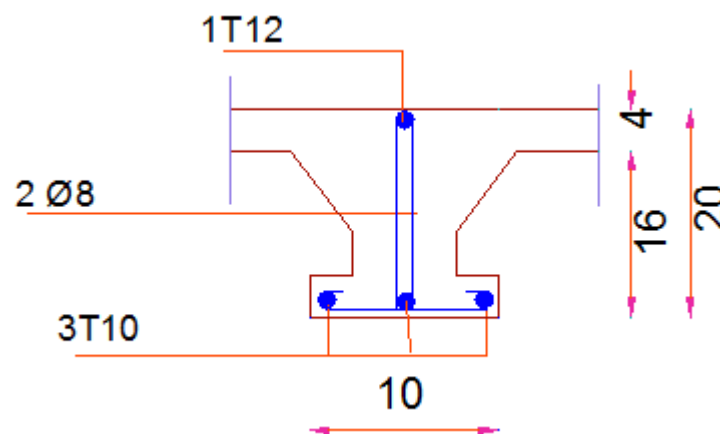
Ferrailage des poutrelles (étage de bureaux).
